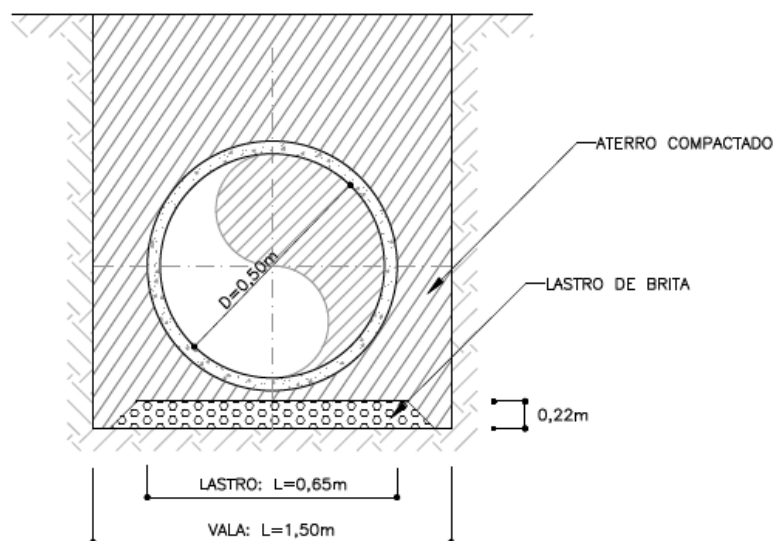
Detalhe para assentamento de tubulação de drenagem de concreto
